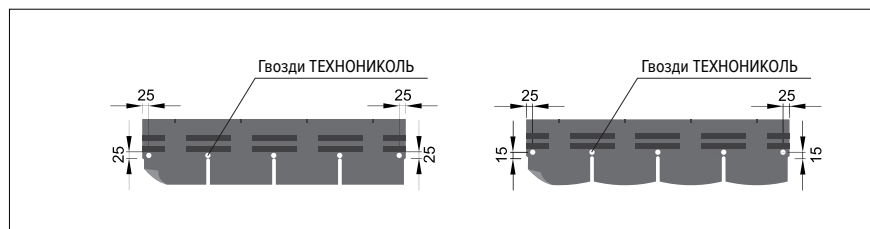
Схема крепления фасадной плитки на 5 гвоздях
